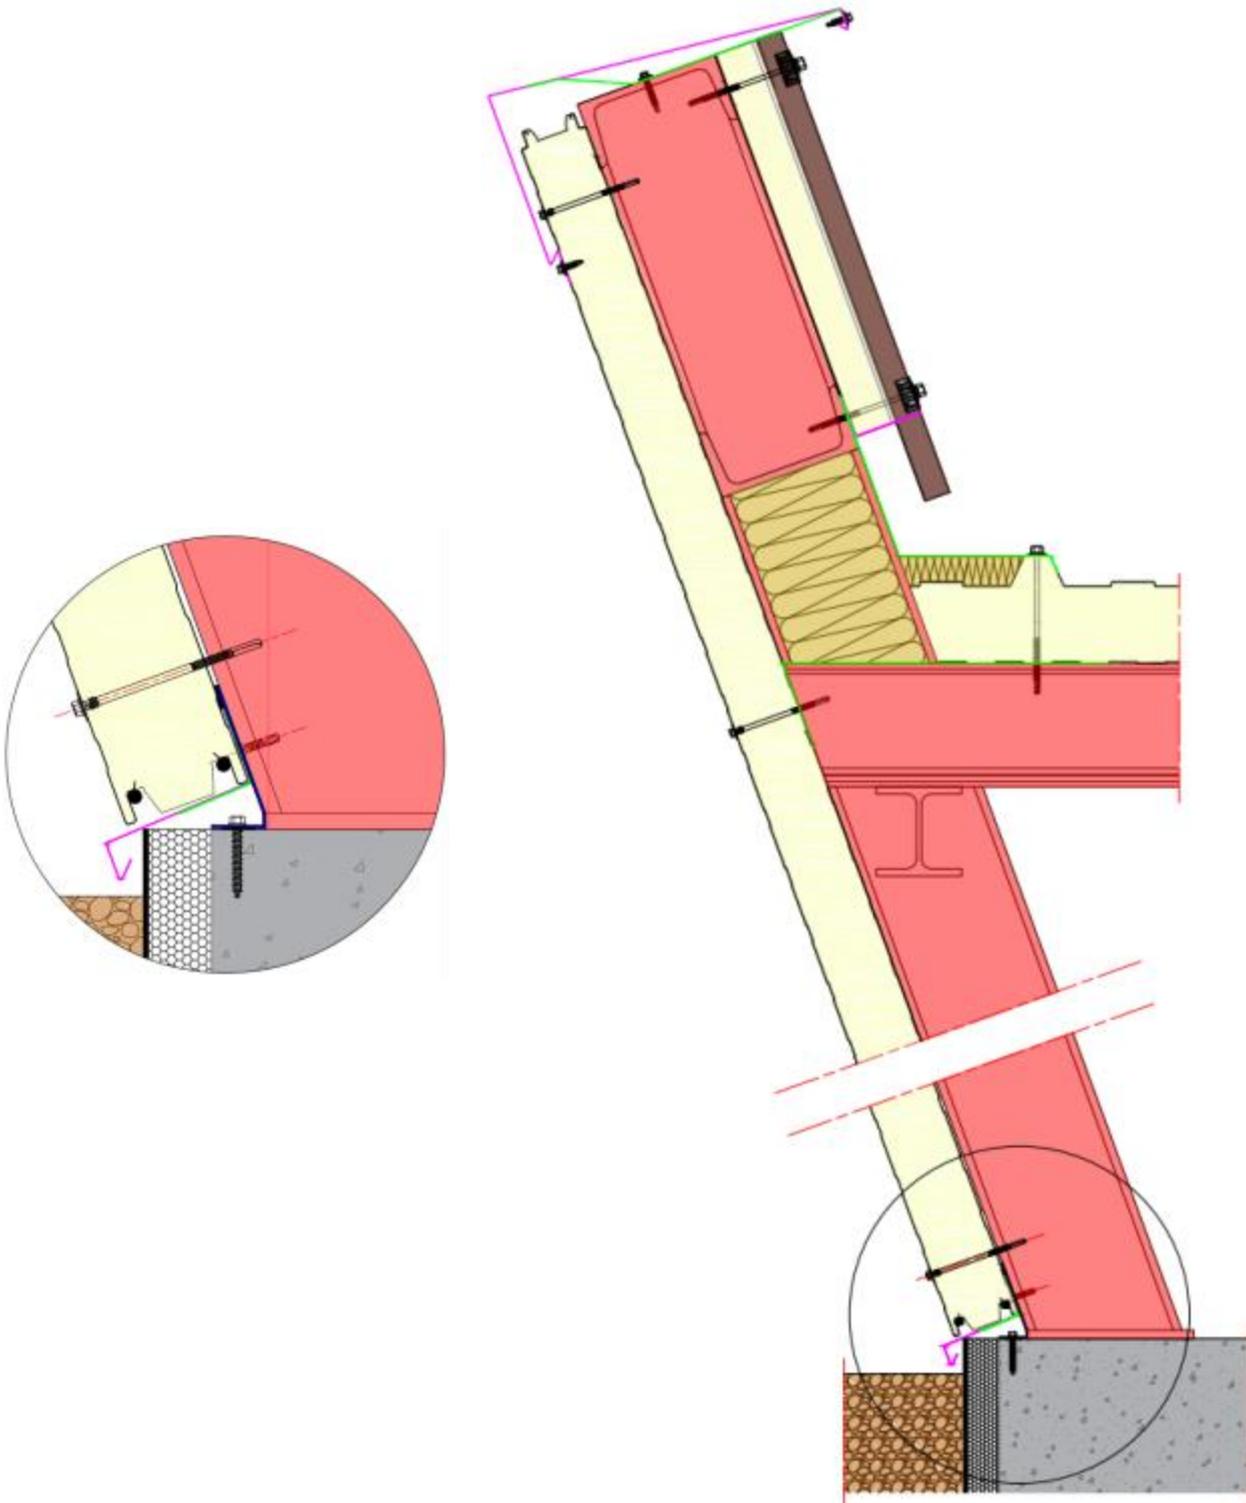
Façade inclinée à fruit négatif maximal de 30° avec panneaux sandwich isolants en pose horizontale
